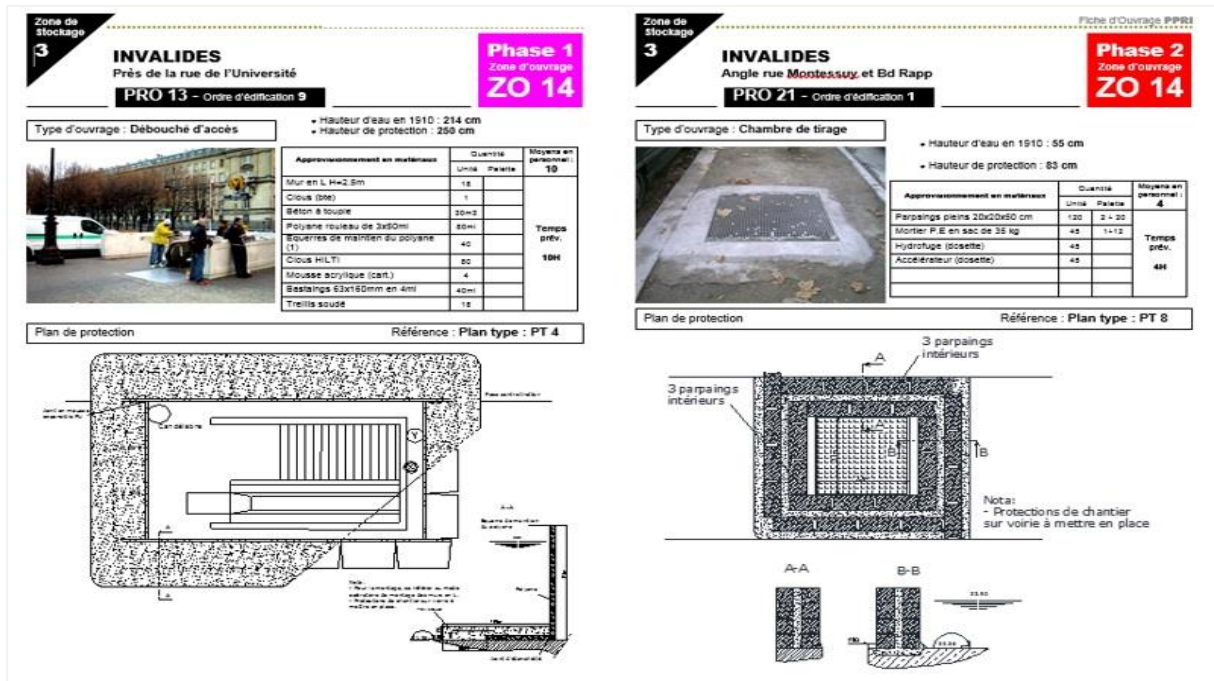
Série de construction de protection pour le PPRI d'un débouché d'accès et d'une trappe de chambre de tirage de la station Invalide.
